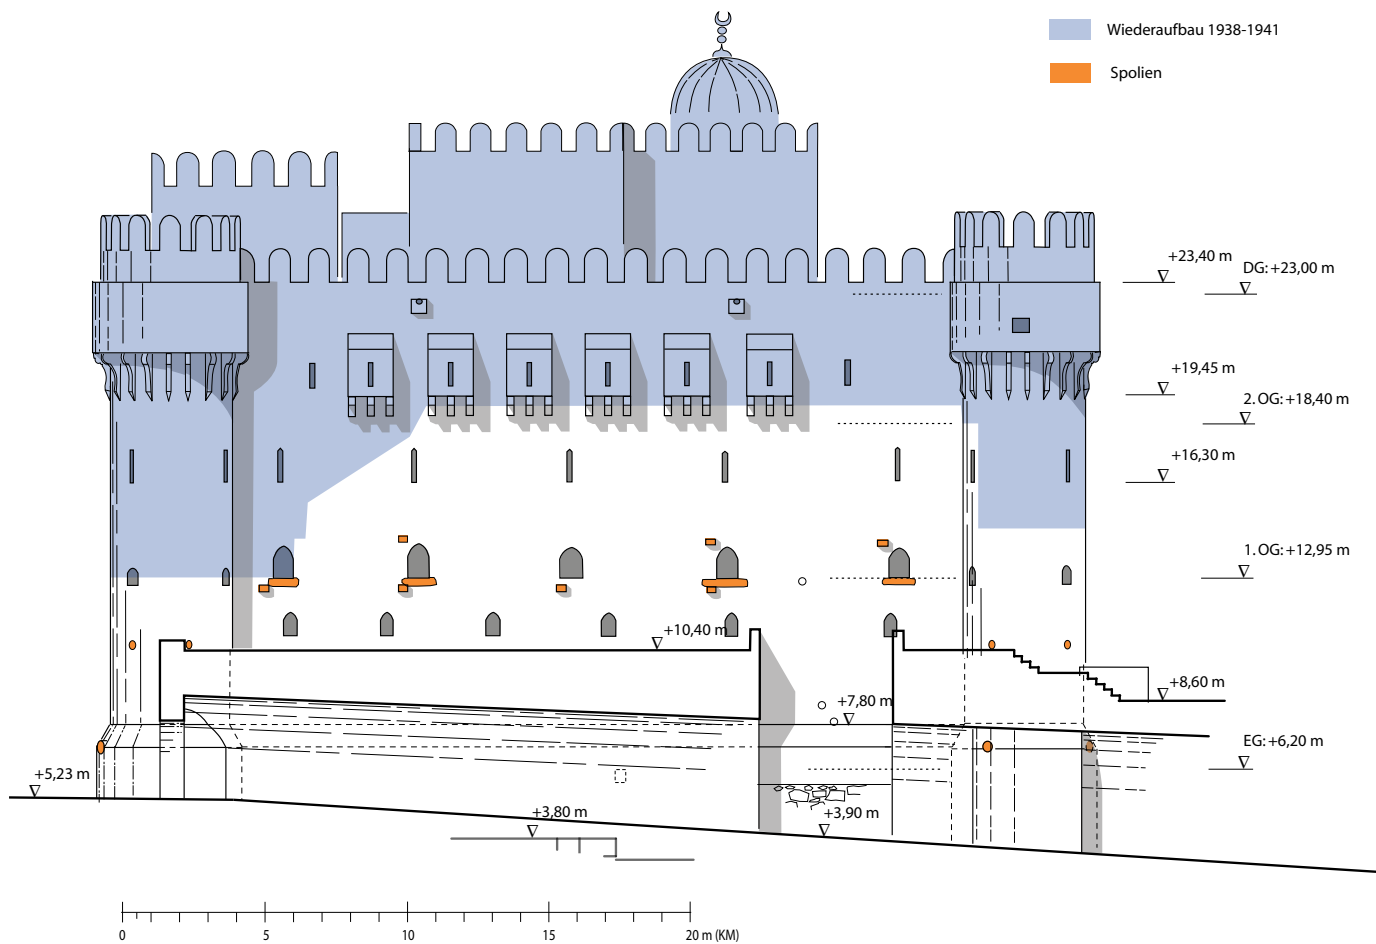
Hauptturm: wiederaufgebaute Ostfassade.
